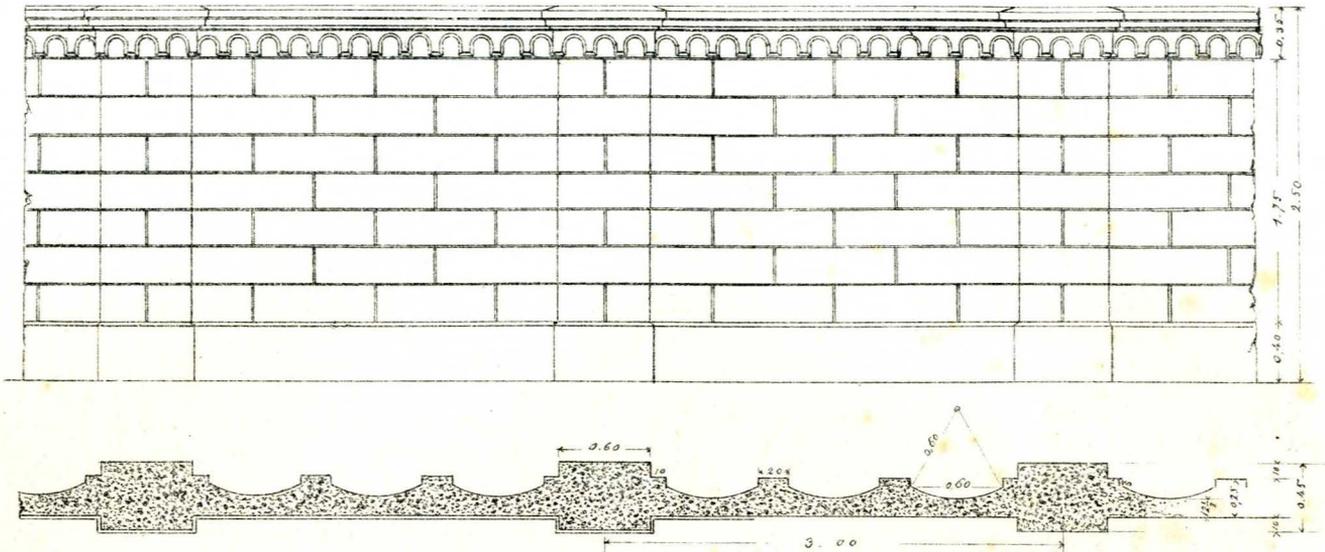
Pianta ed elevazione esterna del muro di cinta. — Scala di 1 a 50.
